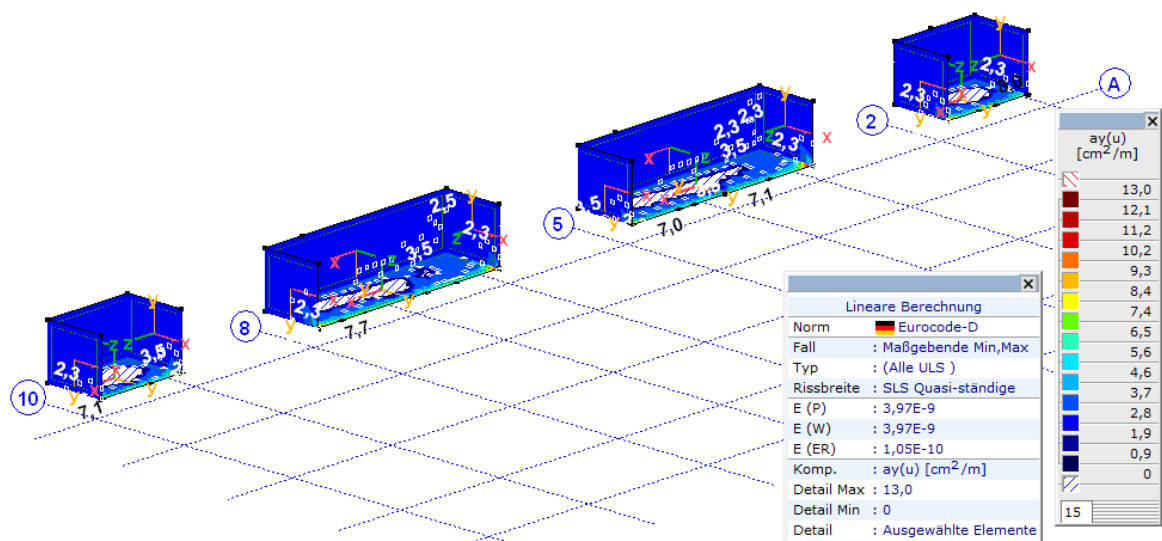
Berechnete Bewehrung außen in lokaler y-Richtung  $a_y(u)$  (vertikal)
